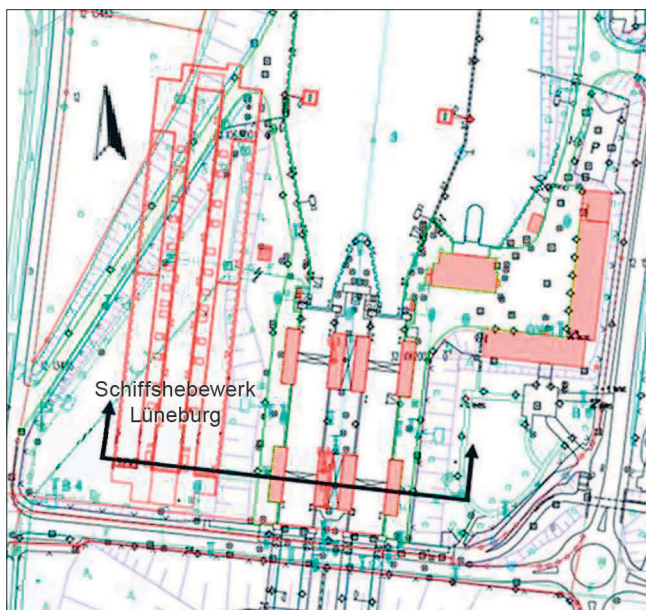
Lageplan SHW Lüneburg und geplante Schleuse einschl. Schnittführung 2D-FEM-Untersuchung
